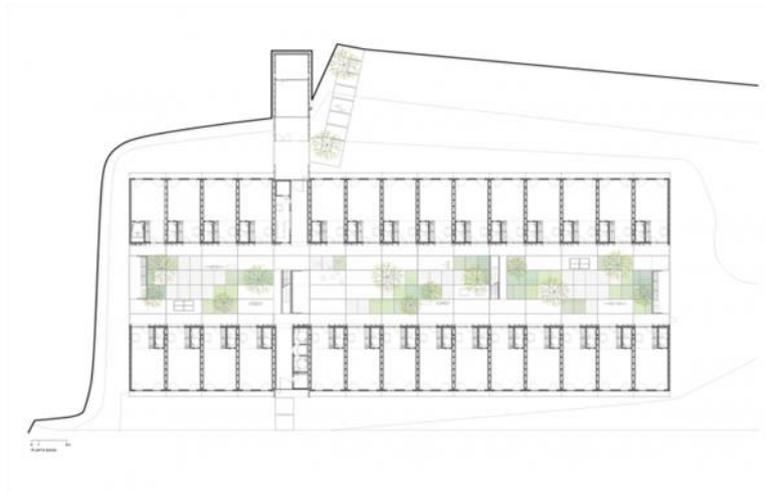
ilustración de planos planta baja-Residencia estudiantil
